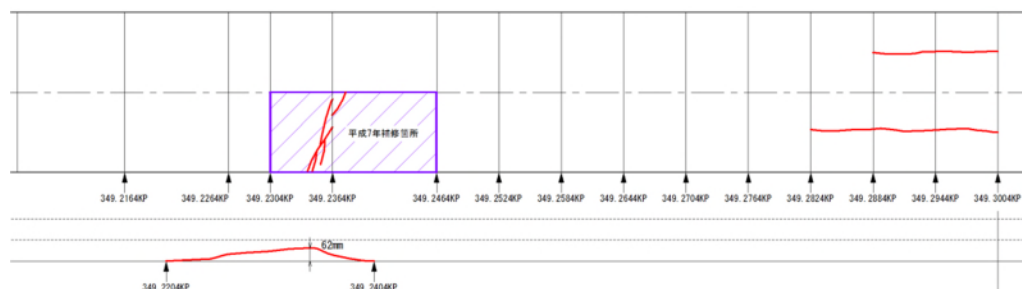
路面のひび割れと隆起状況（完成 8 年後）
